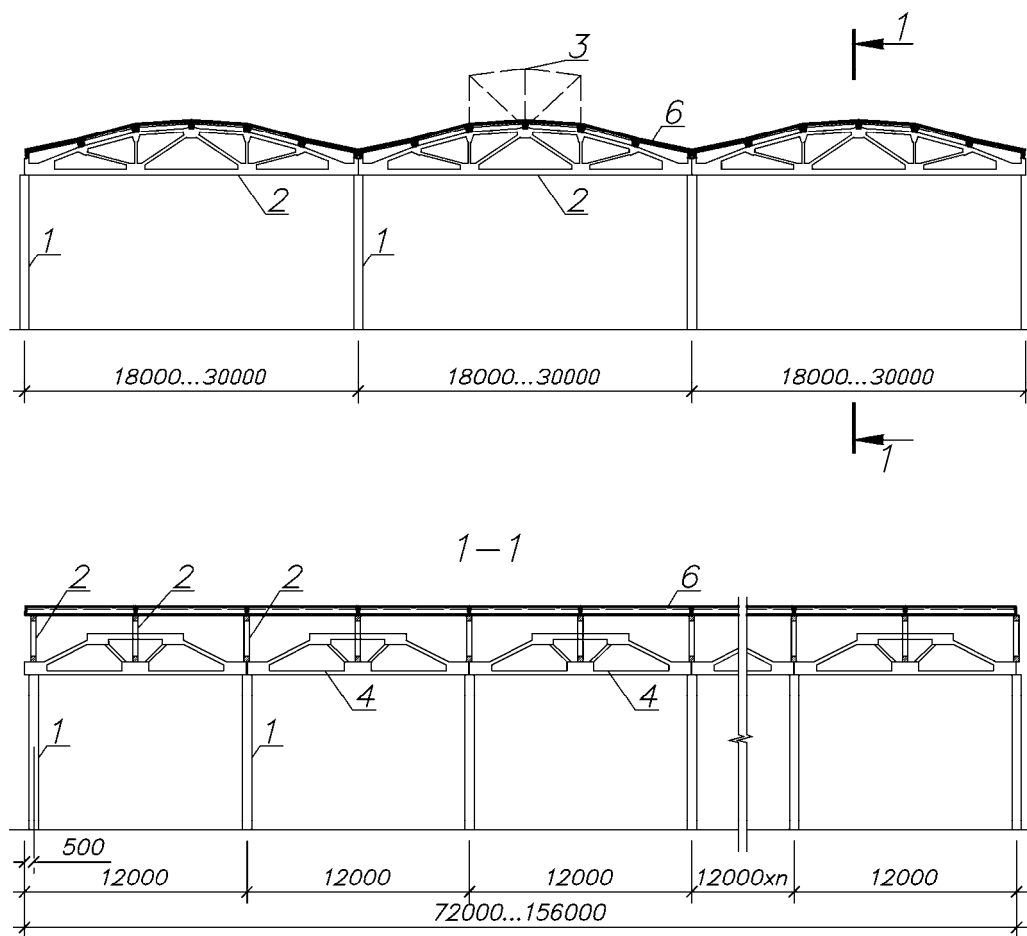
Конструктивная схема здания со скатной кровлей при шаге колонн средних рядов 12 м, шаге стропильных ферм 6 м, устанавливаемых на подстропильные фермы:
